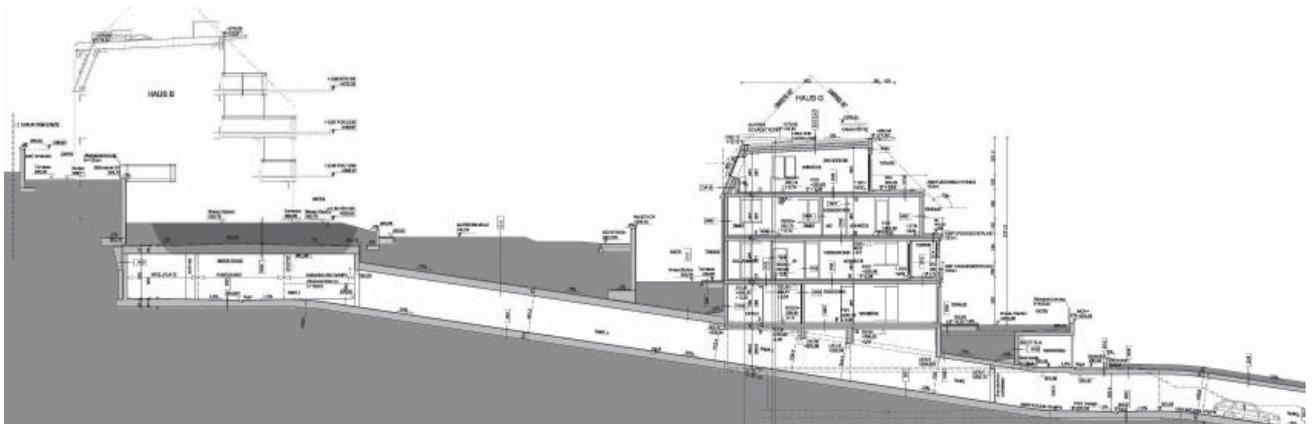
Schnitt Wohnhausanlage Purkersdorf Wintergasse, Quelle: Arch. Rainer
